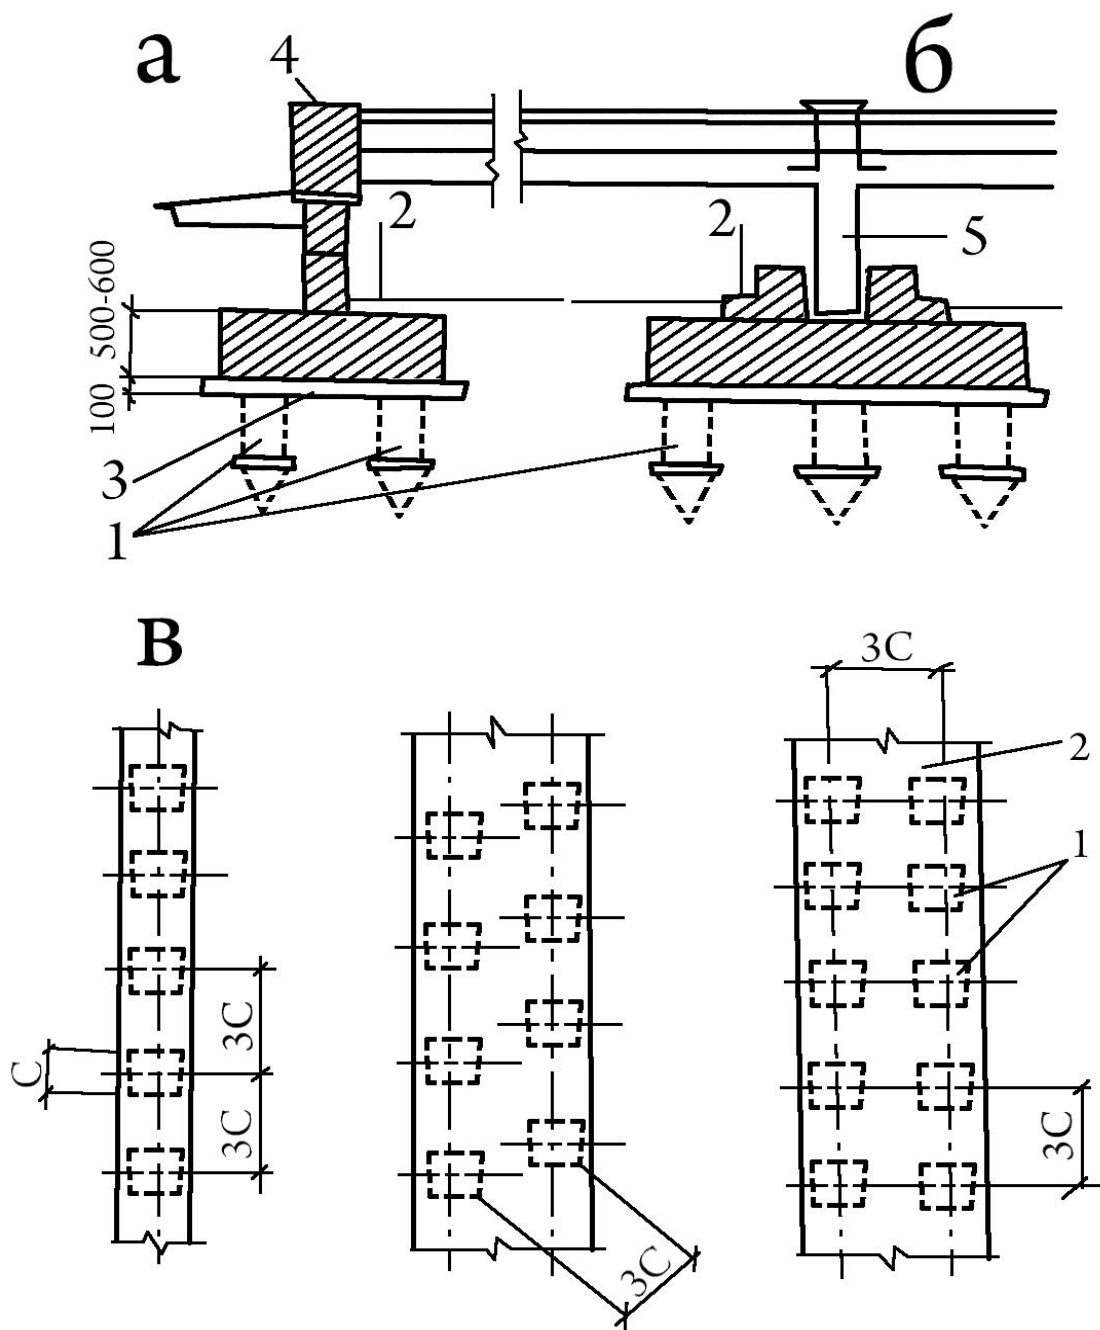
Свайные фундаменты: а – под стены; б - под колонны; в - примеры расстановки свай в плане; 1 - сваи; 2 - железобетонный ростверк; 3 - бетонная подготовка; 4 - стеновые блоки; 5 – колонна
